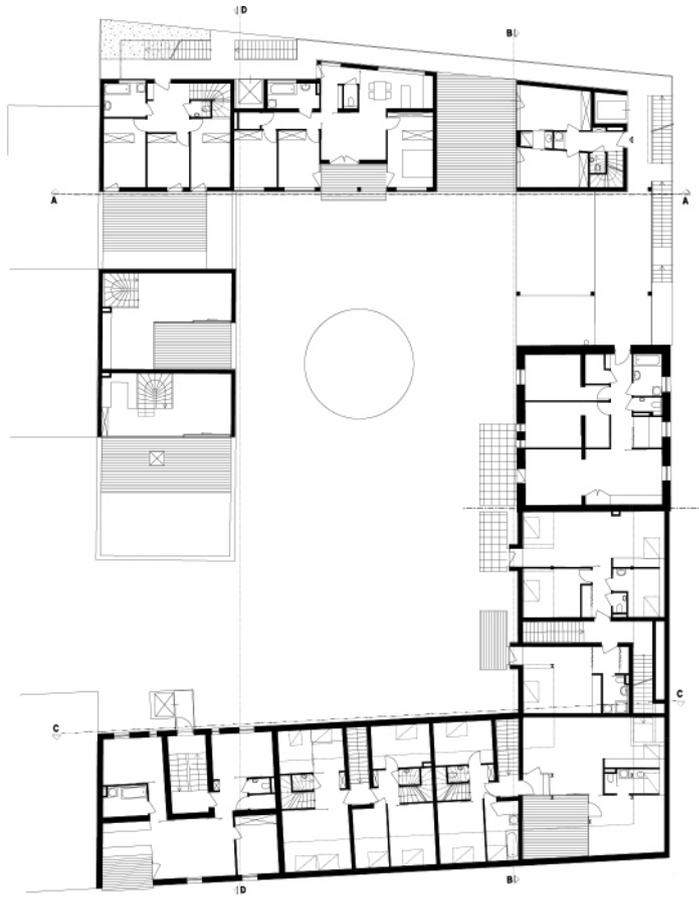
Grundriss 1.OG, © INNOCAD ZT
